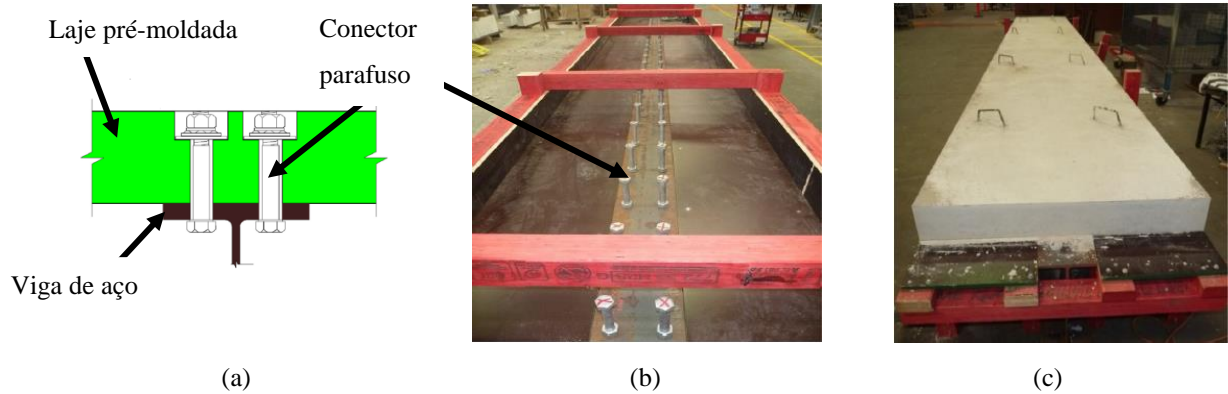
Conectores parafusos em elementos de vigas mistas (Ataei *et al.*, 2016): (a) ilustração do sistema, (b) modelo para ensaio antes da instalação da laje pré-moldada, (c) modelo para ensaio após a instalação da laje pré-moldada.
